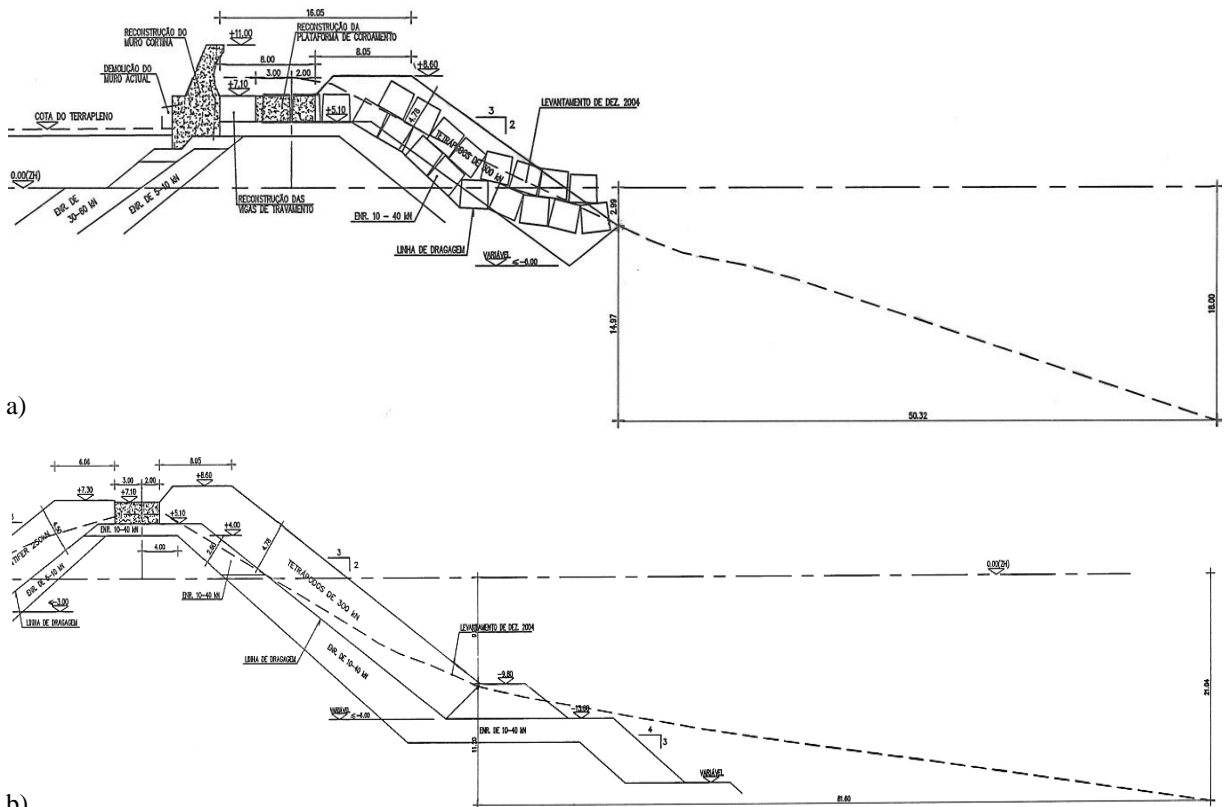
Perfis do quebra-mar sul: a) Perfil D3 - perfil junto ao Cais 12; b) Perfil D8 – perfil entre o Cais 12 e a cabeça do quebra-mar.
